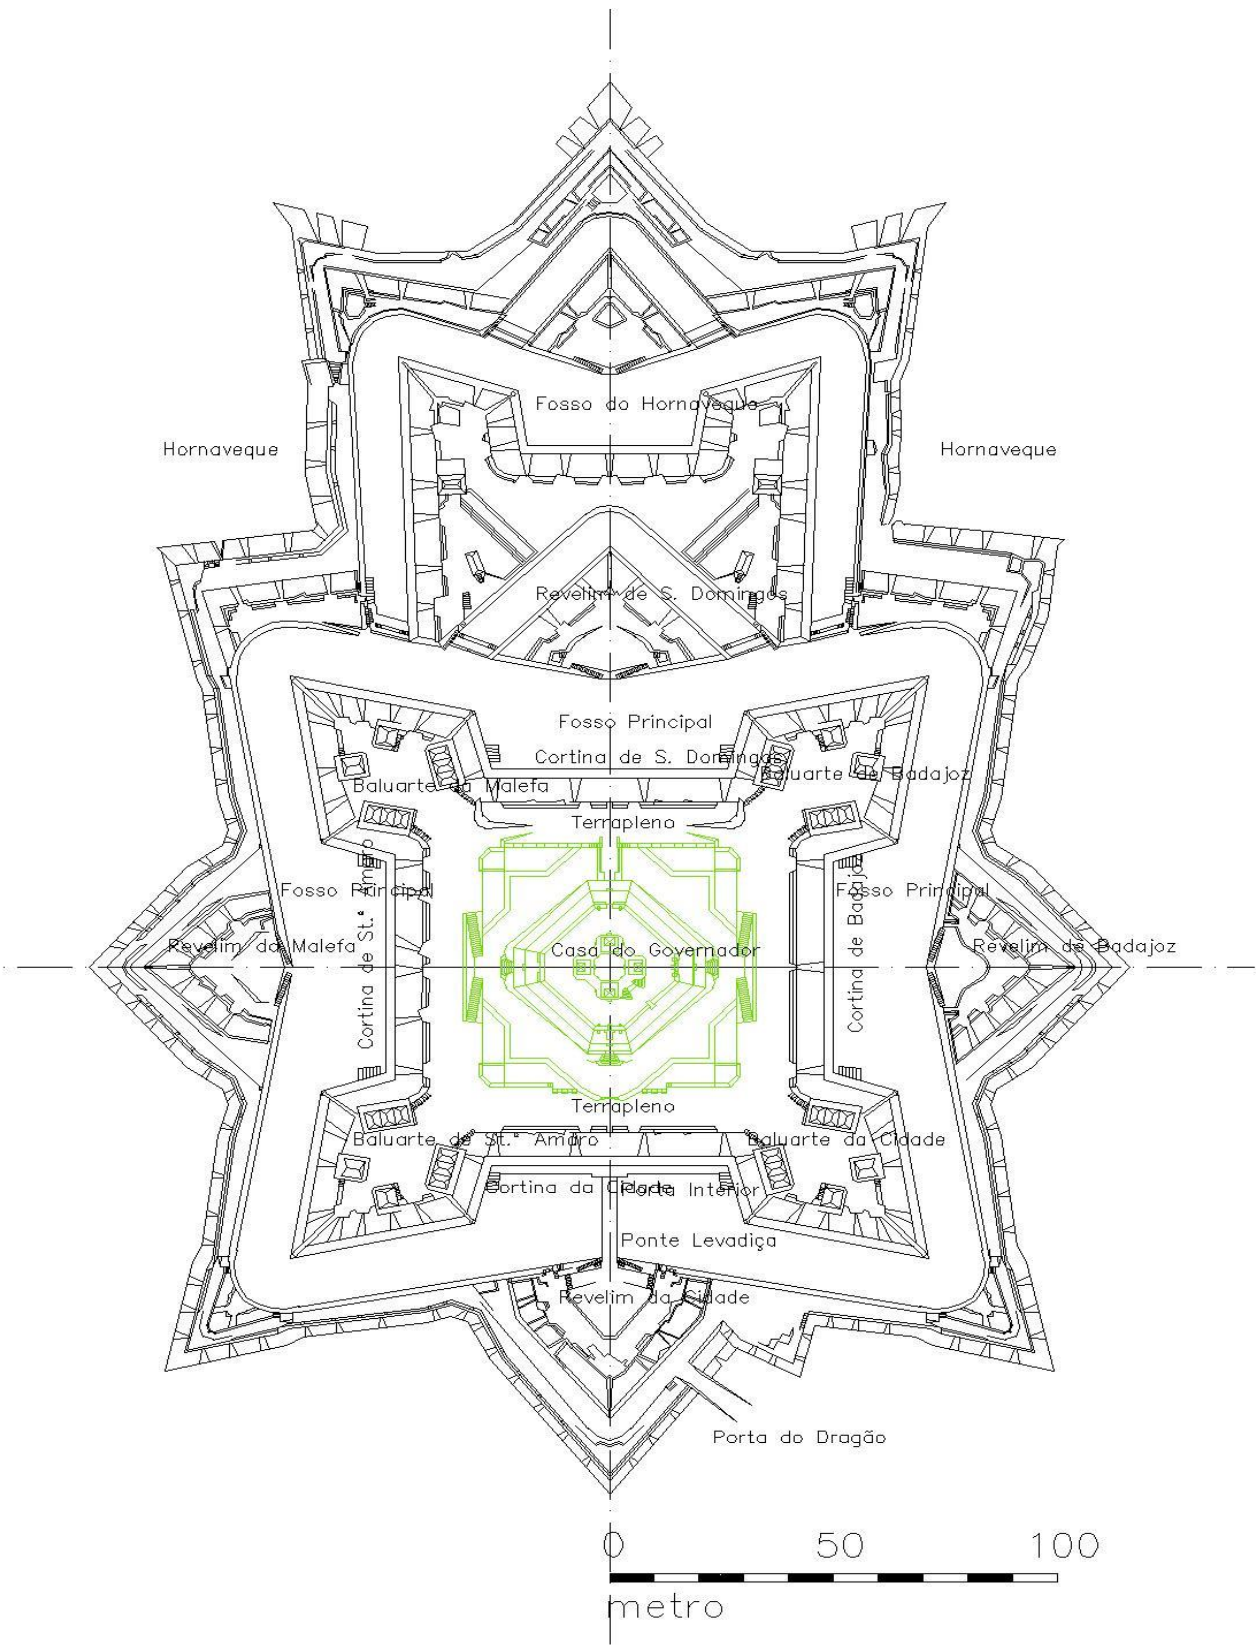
Planta do piso térreo do Forte da Graça ⁵⁰
